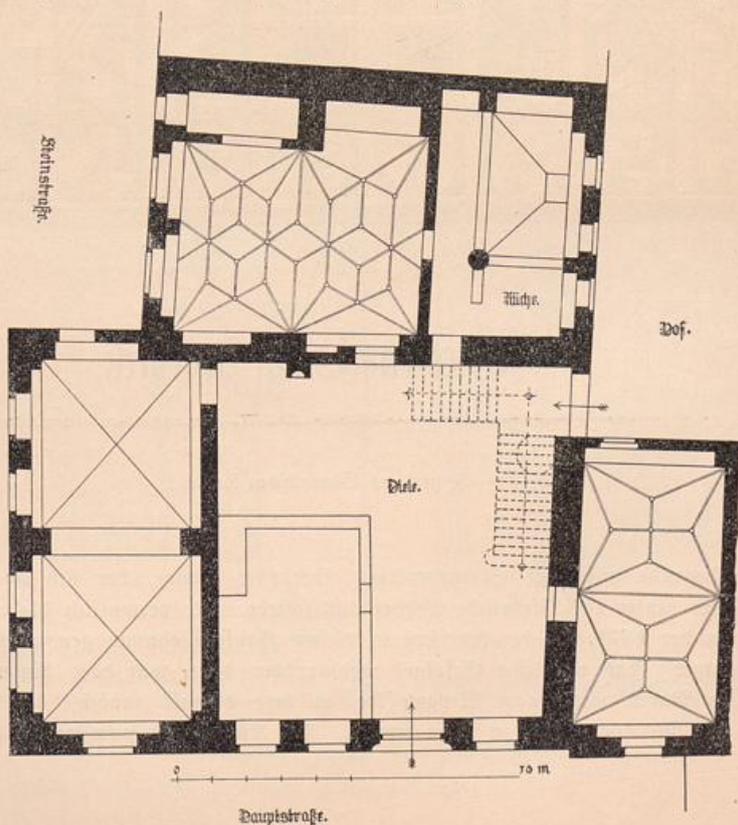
Erdgeschoßgrundriß des ehemaligen Hauses Storbek.
